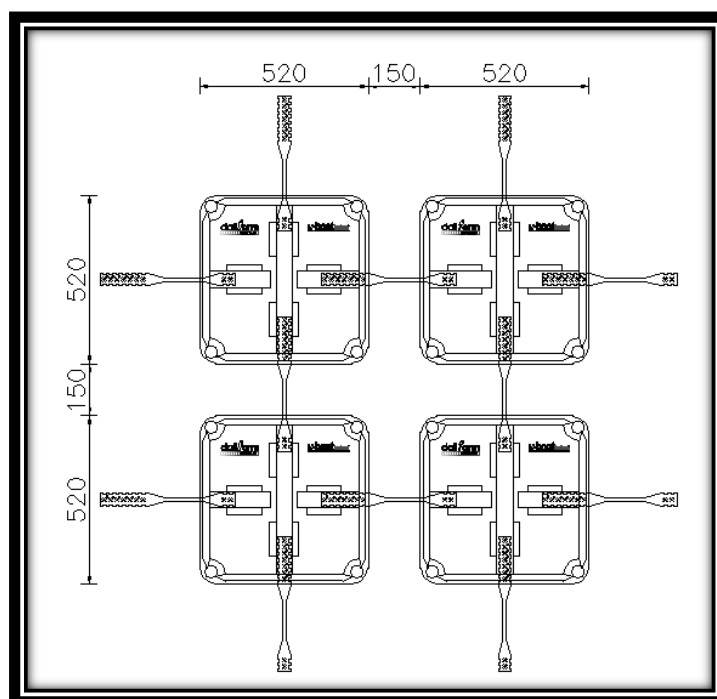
Sección de la losa U-Boot Beton h=30 cm.
